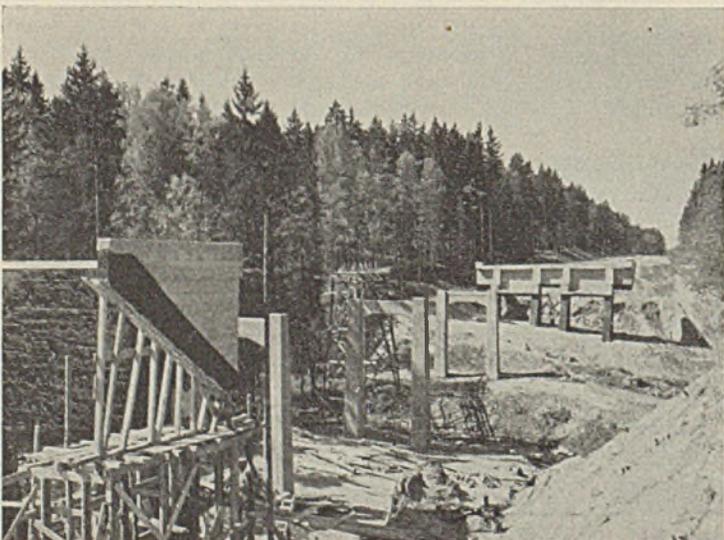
Pfeiler und Widerlager des Bauwerks 165, Bahnauviadukt.
